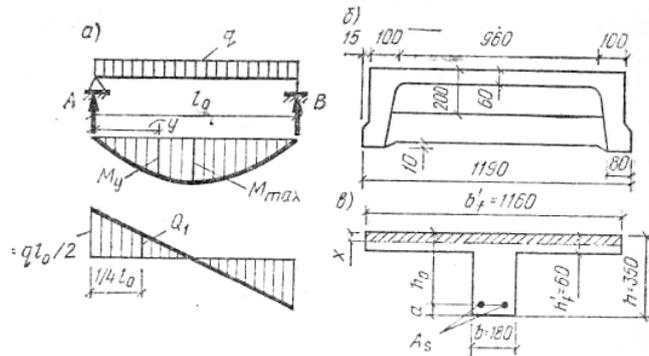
К расчету ребристой панели перекрытия по примеру 3.
